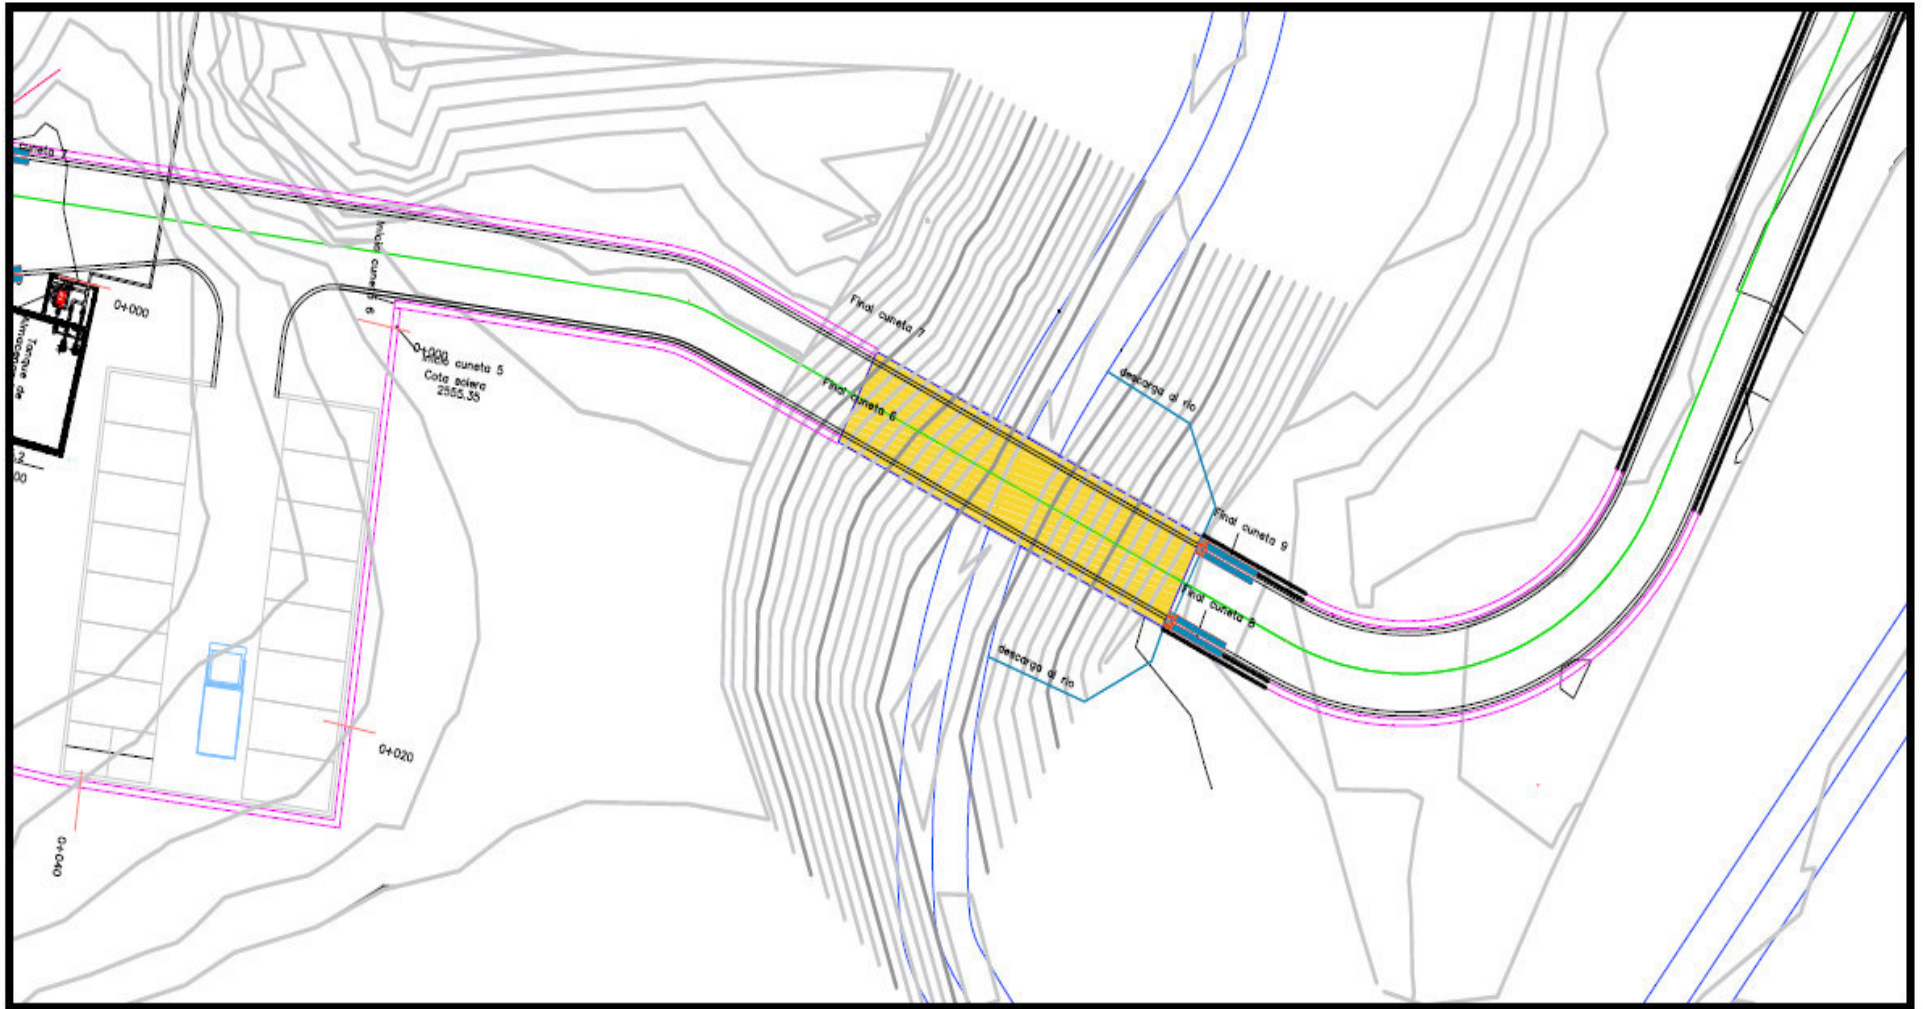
Plano en planta de la nueva implantación de la PTAP. (Parte 3)
